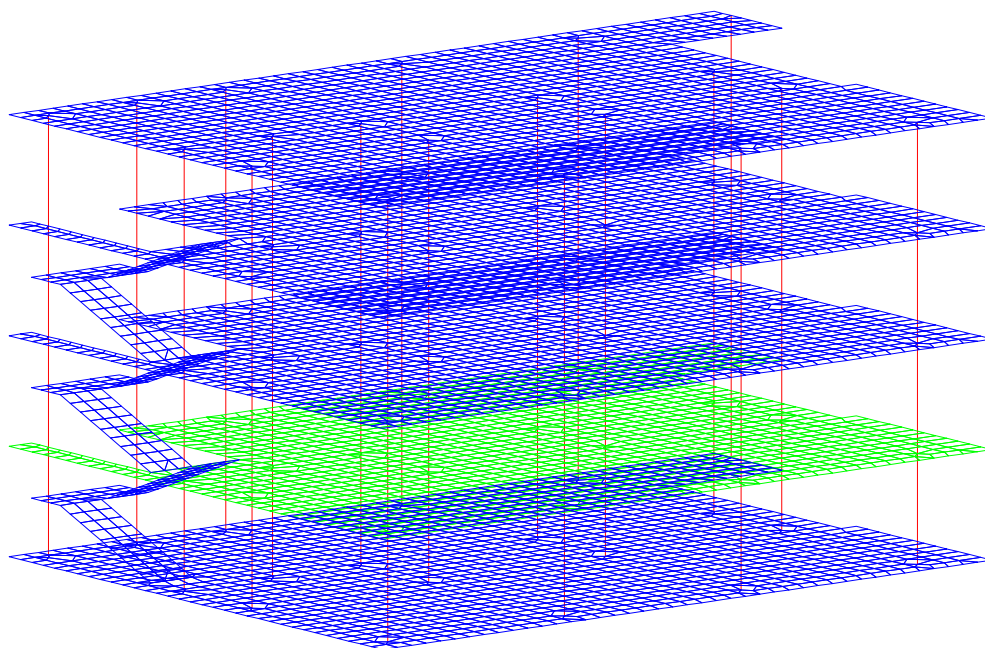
Схема будівлі (виділено покриття, що розраховується)
